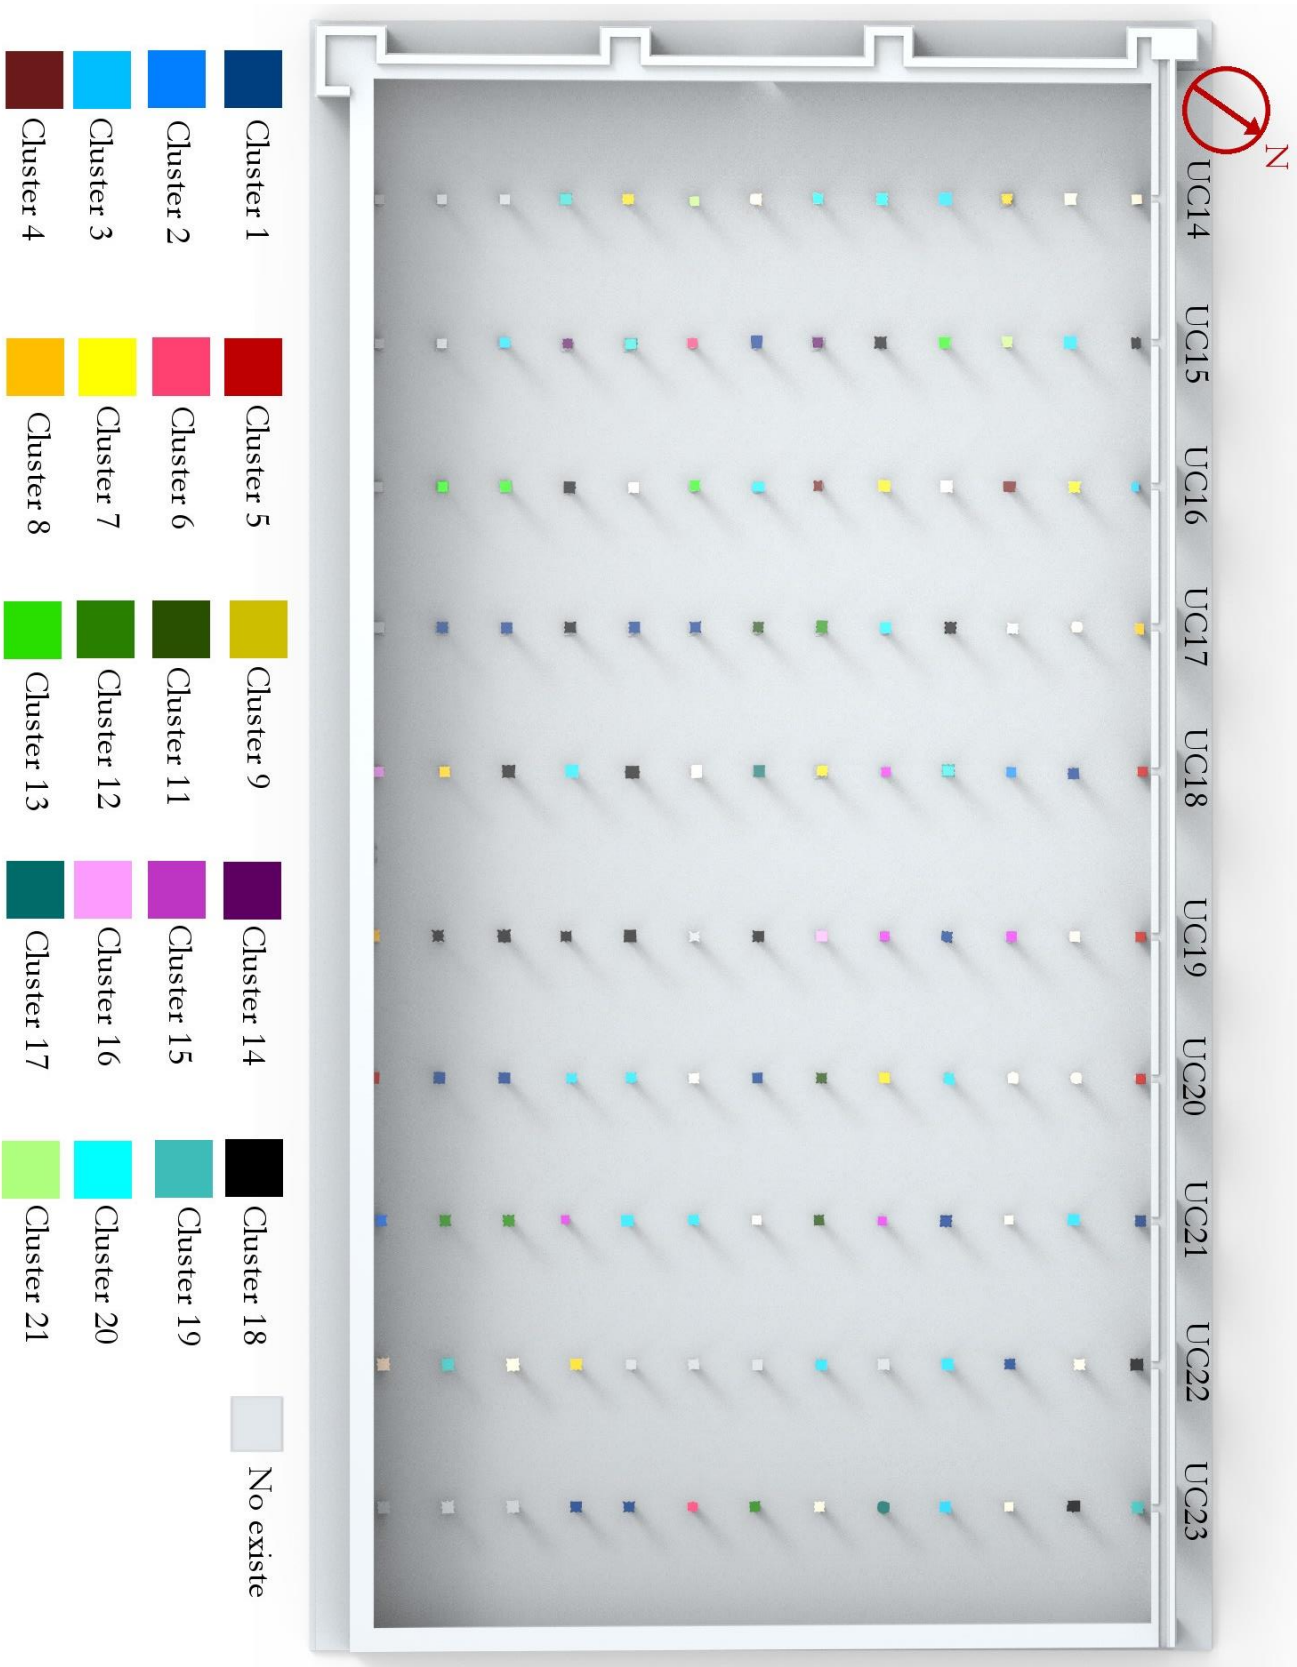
Planta de los Clúster de los capiteles en la planta original.
